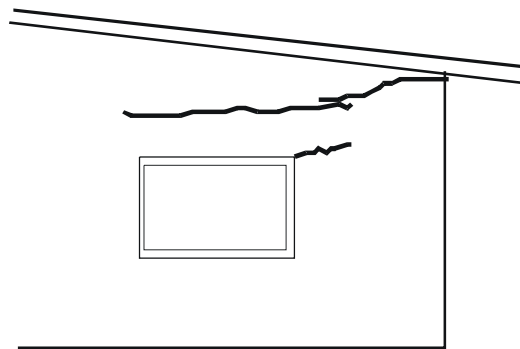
fissuras horizontais em parede por retração da laje de cobertura (THOMAZ, 1989)
